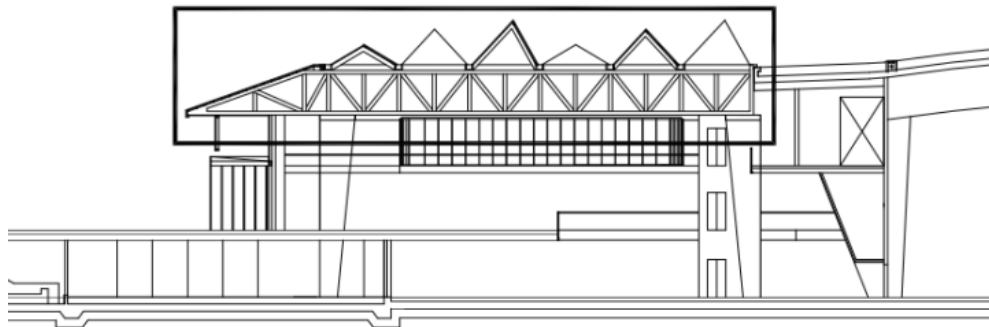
Sistema estructural de la cubierta del Centro de Convenciones de Buenos Aires
